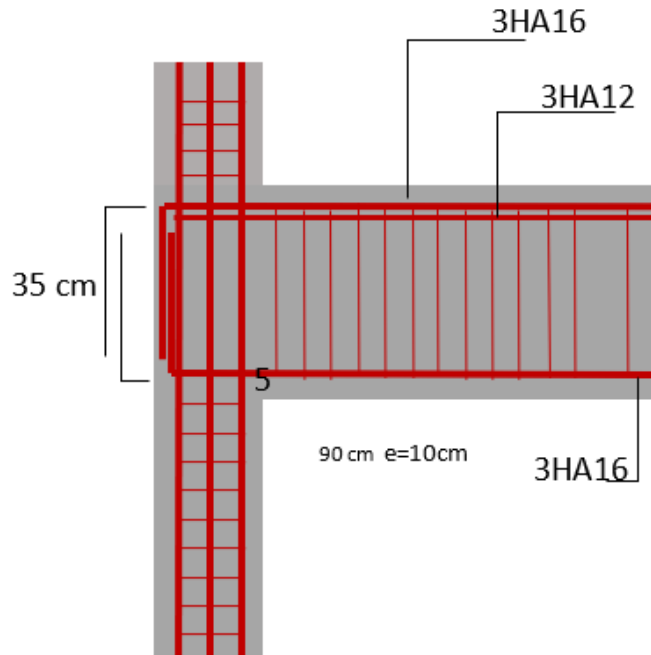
Ferrailage en appui de rive -Poutre principale
